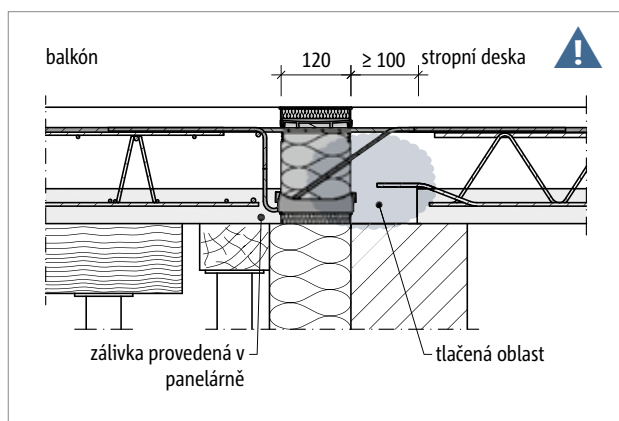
Schöck Isokorb® XT typ KL: Prefabrikovaný balkón, jehož spodní hrana je snižena vůči stropní desce uložené na předem vybetonované železobetonové stěně
